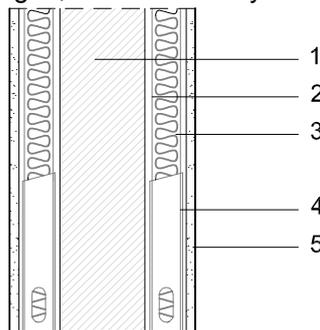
Ejemplo de elemento de separación de tipo 1. Elemento base de fábrica, trasdosado por ambos lados con 2 placas de yeso laminado ancladas a una perfilería metálica autoportante.
